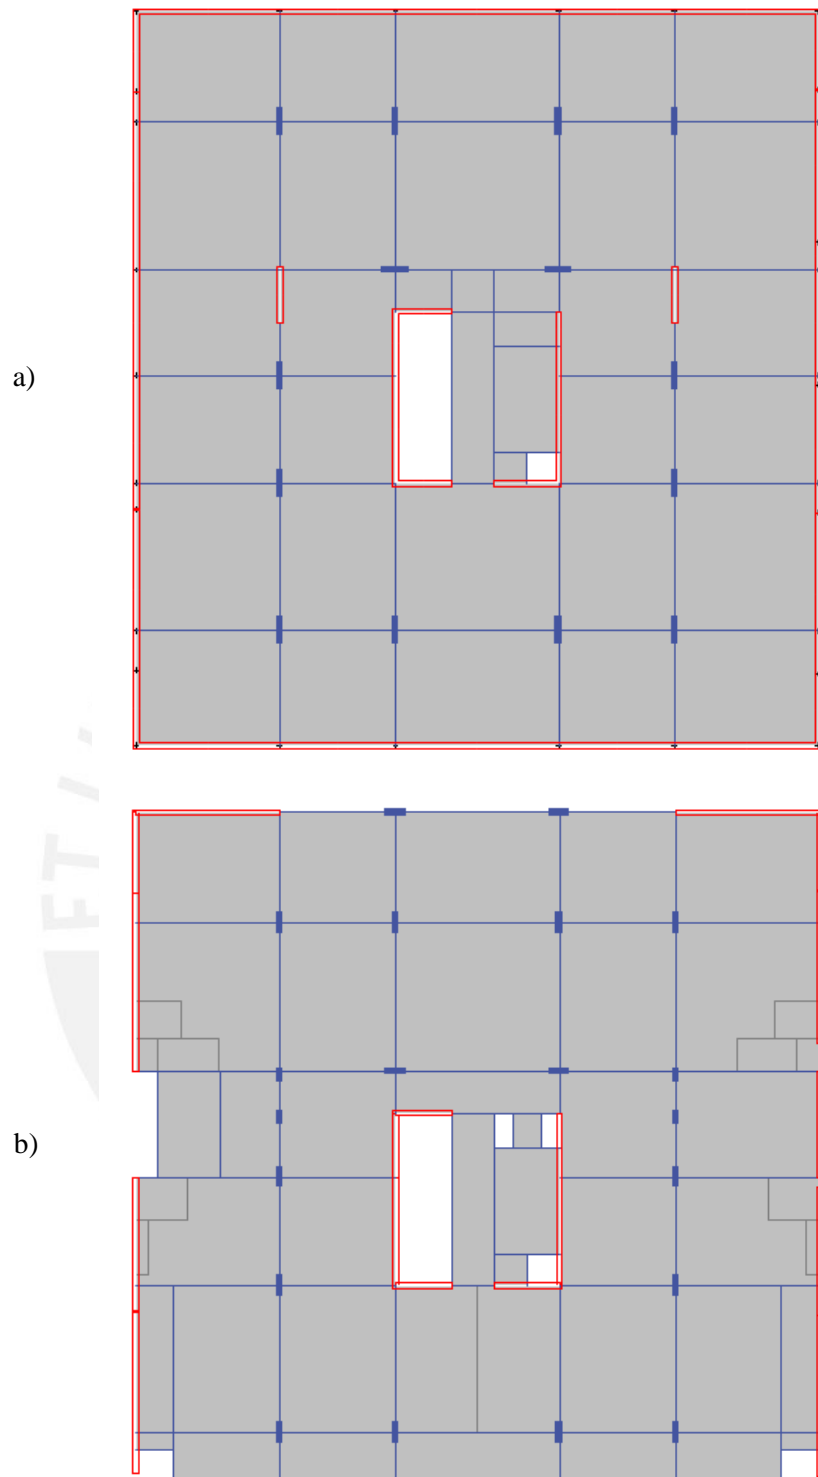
Planta estructural: (a) sótano; y (b) piso superior.
